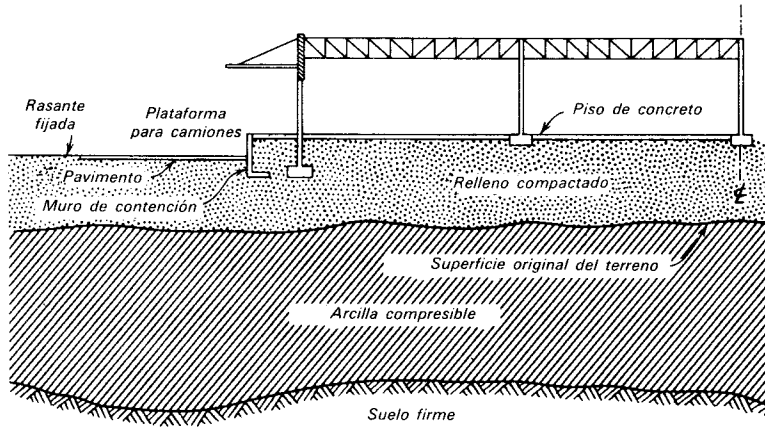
Sección transversal en un edificio para industria ligera sobre suelo compactado.
